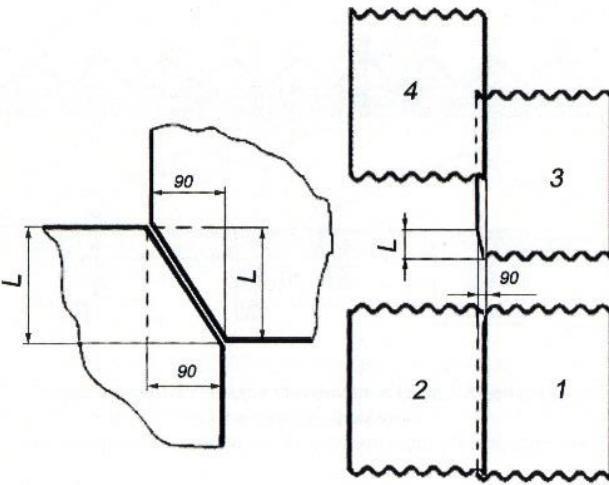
Схема обрезки углов перекрываемой и перекрывающей кромок листов СВ:
